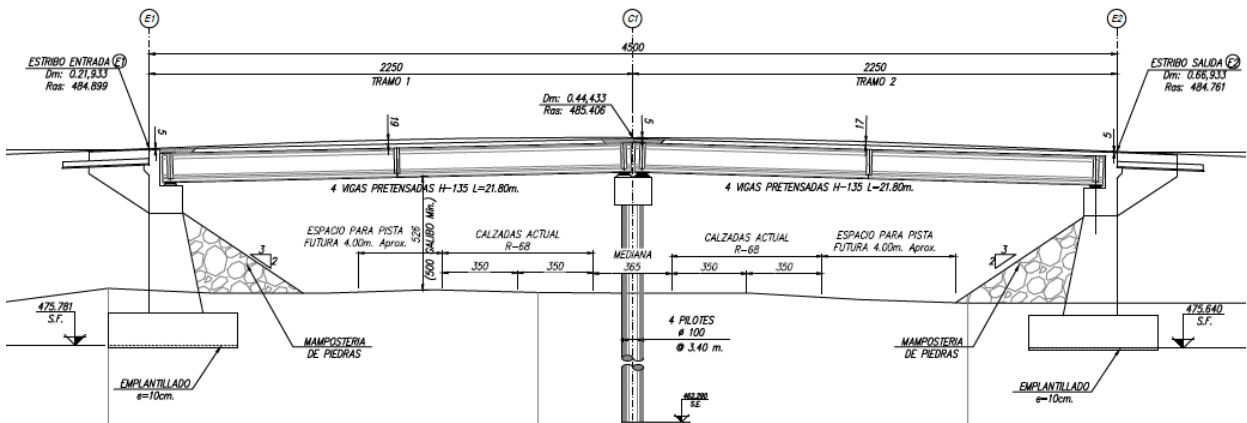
Elevación Longitudinal Puente San Pablo Antigua Fuente: Planos de Proyecto.
